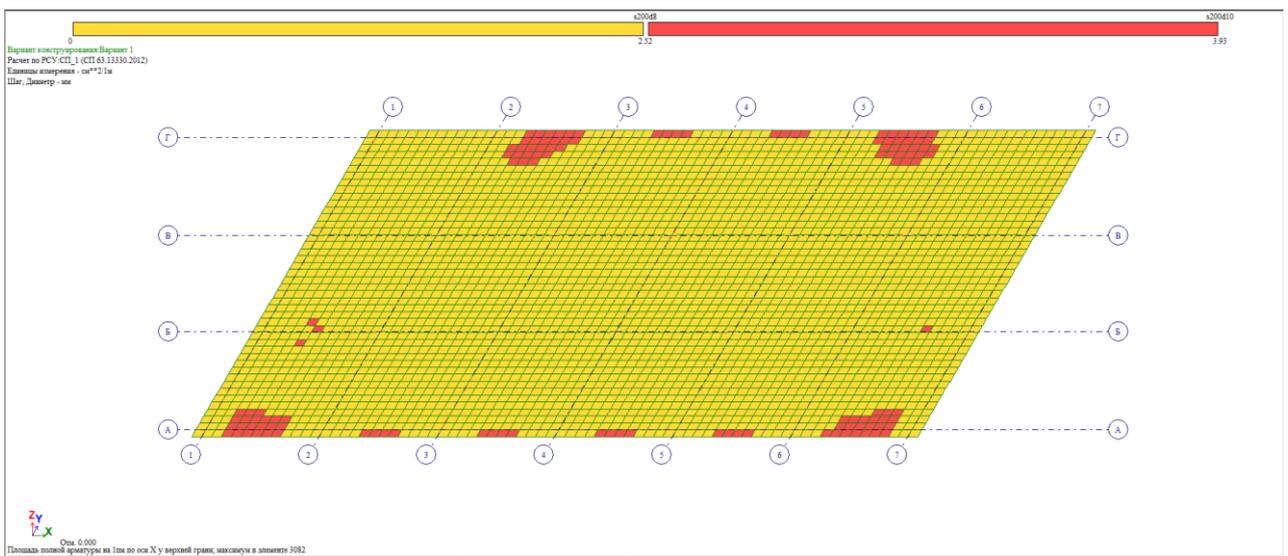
Площадь арматуры по оси X у верхней грани
